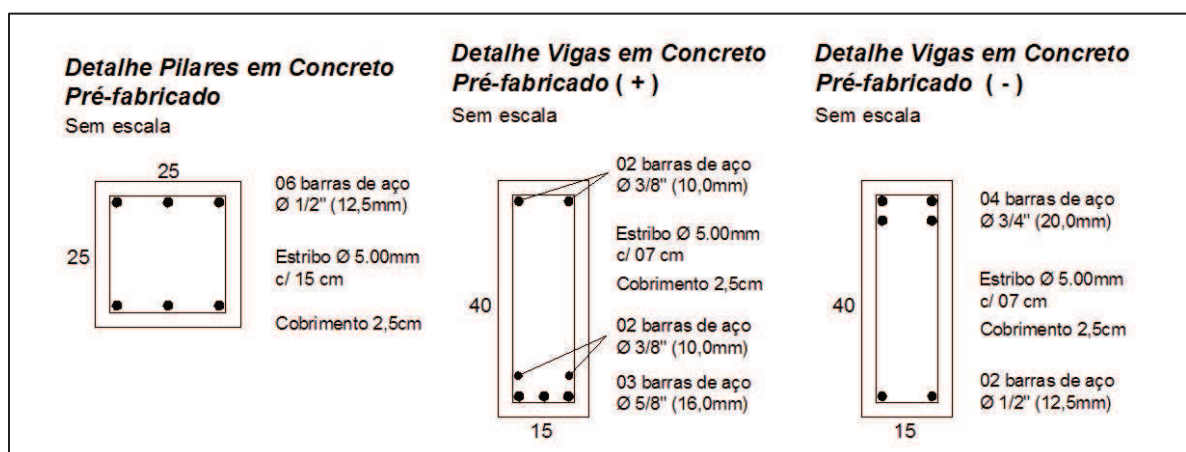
Detalhe seção vigas e pilares- Modelo III.
